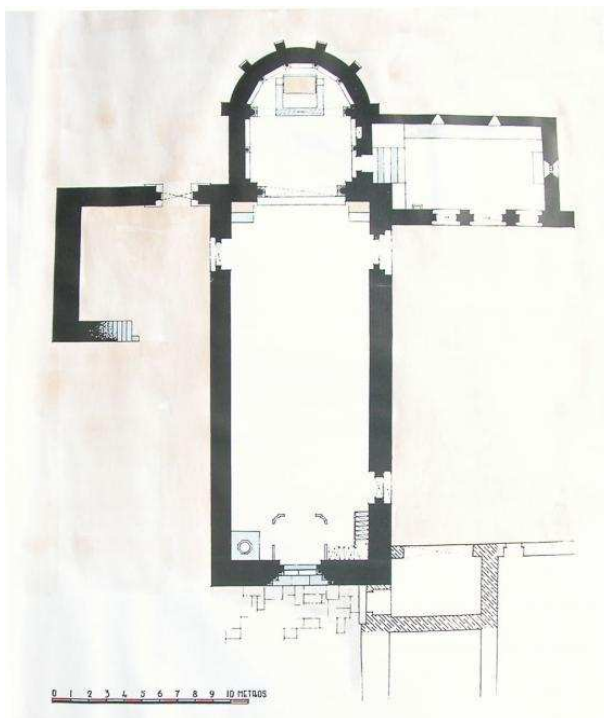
Planta da igreja de São Pedro de Roriz [74]
